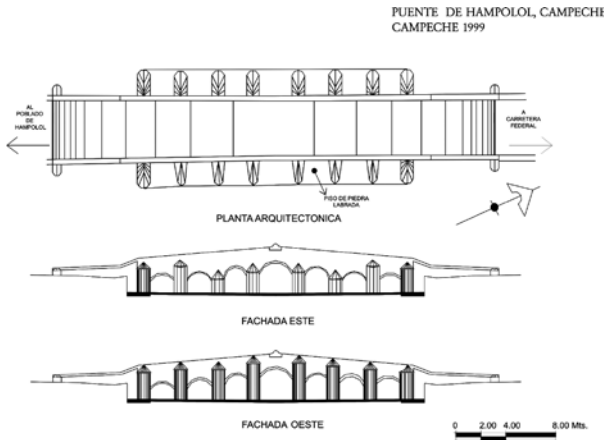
Alzado y planta arquitectónica del puente de Hampolol.
